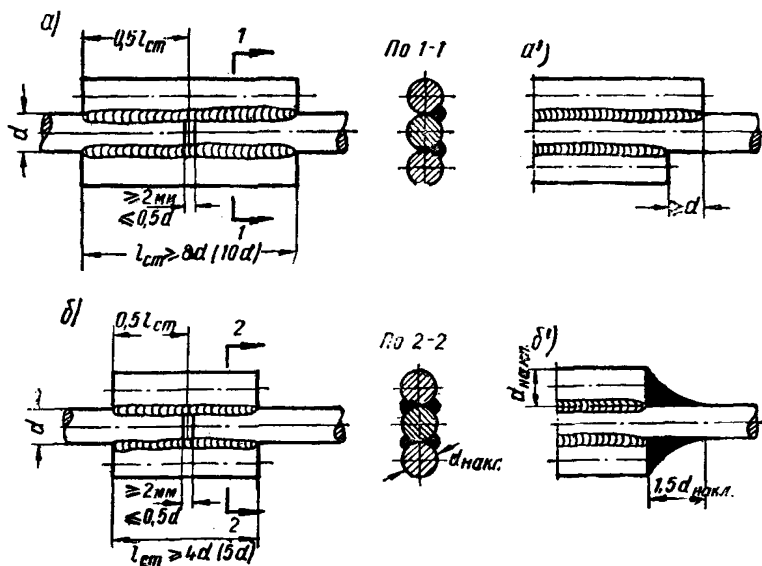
Стыки стержней электродуговой сваркой с двумя накладками из стержней
